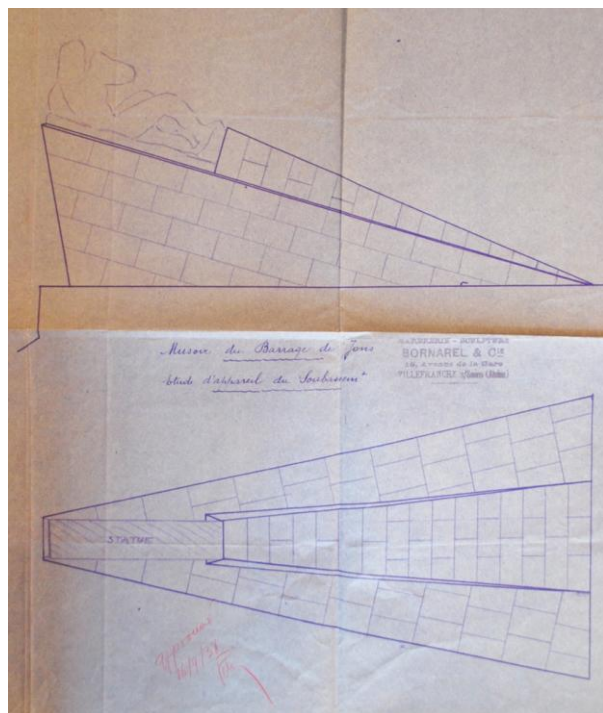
Appareil du soubassement de la sculpture « Le Rhône couché » (A.D.R. 156J154)
